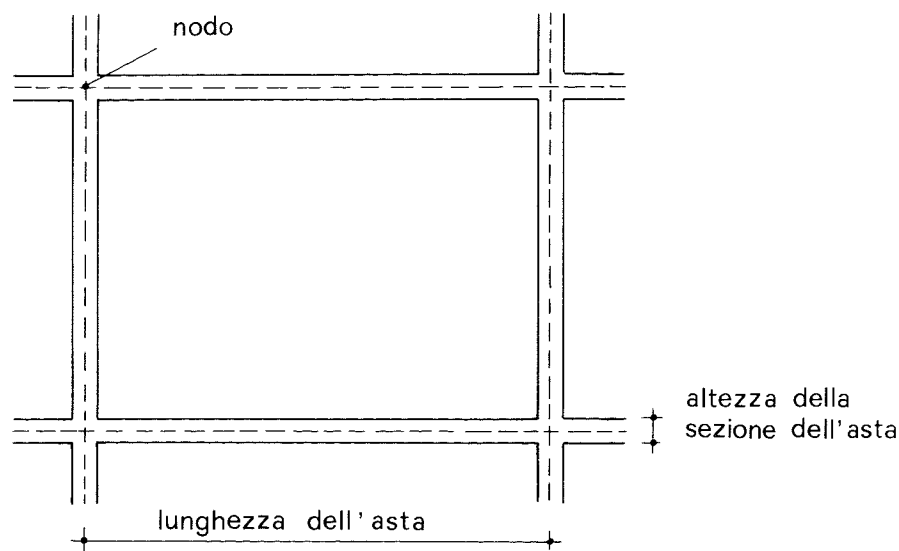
Telaio: aste con dimensioni della sezione piccole rispetto alla luce.
